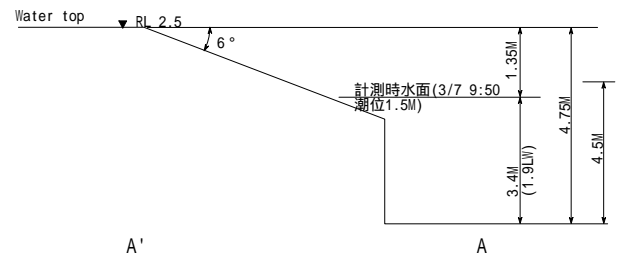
ニウアトプタブ埠頭断面図 (A-A' 断面)
